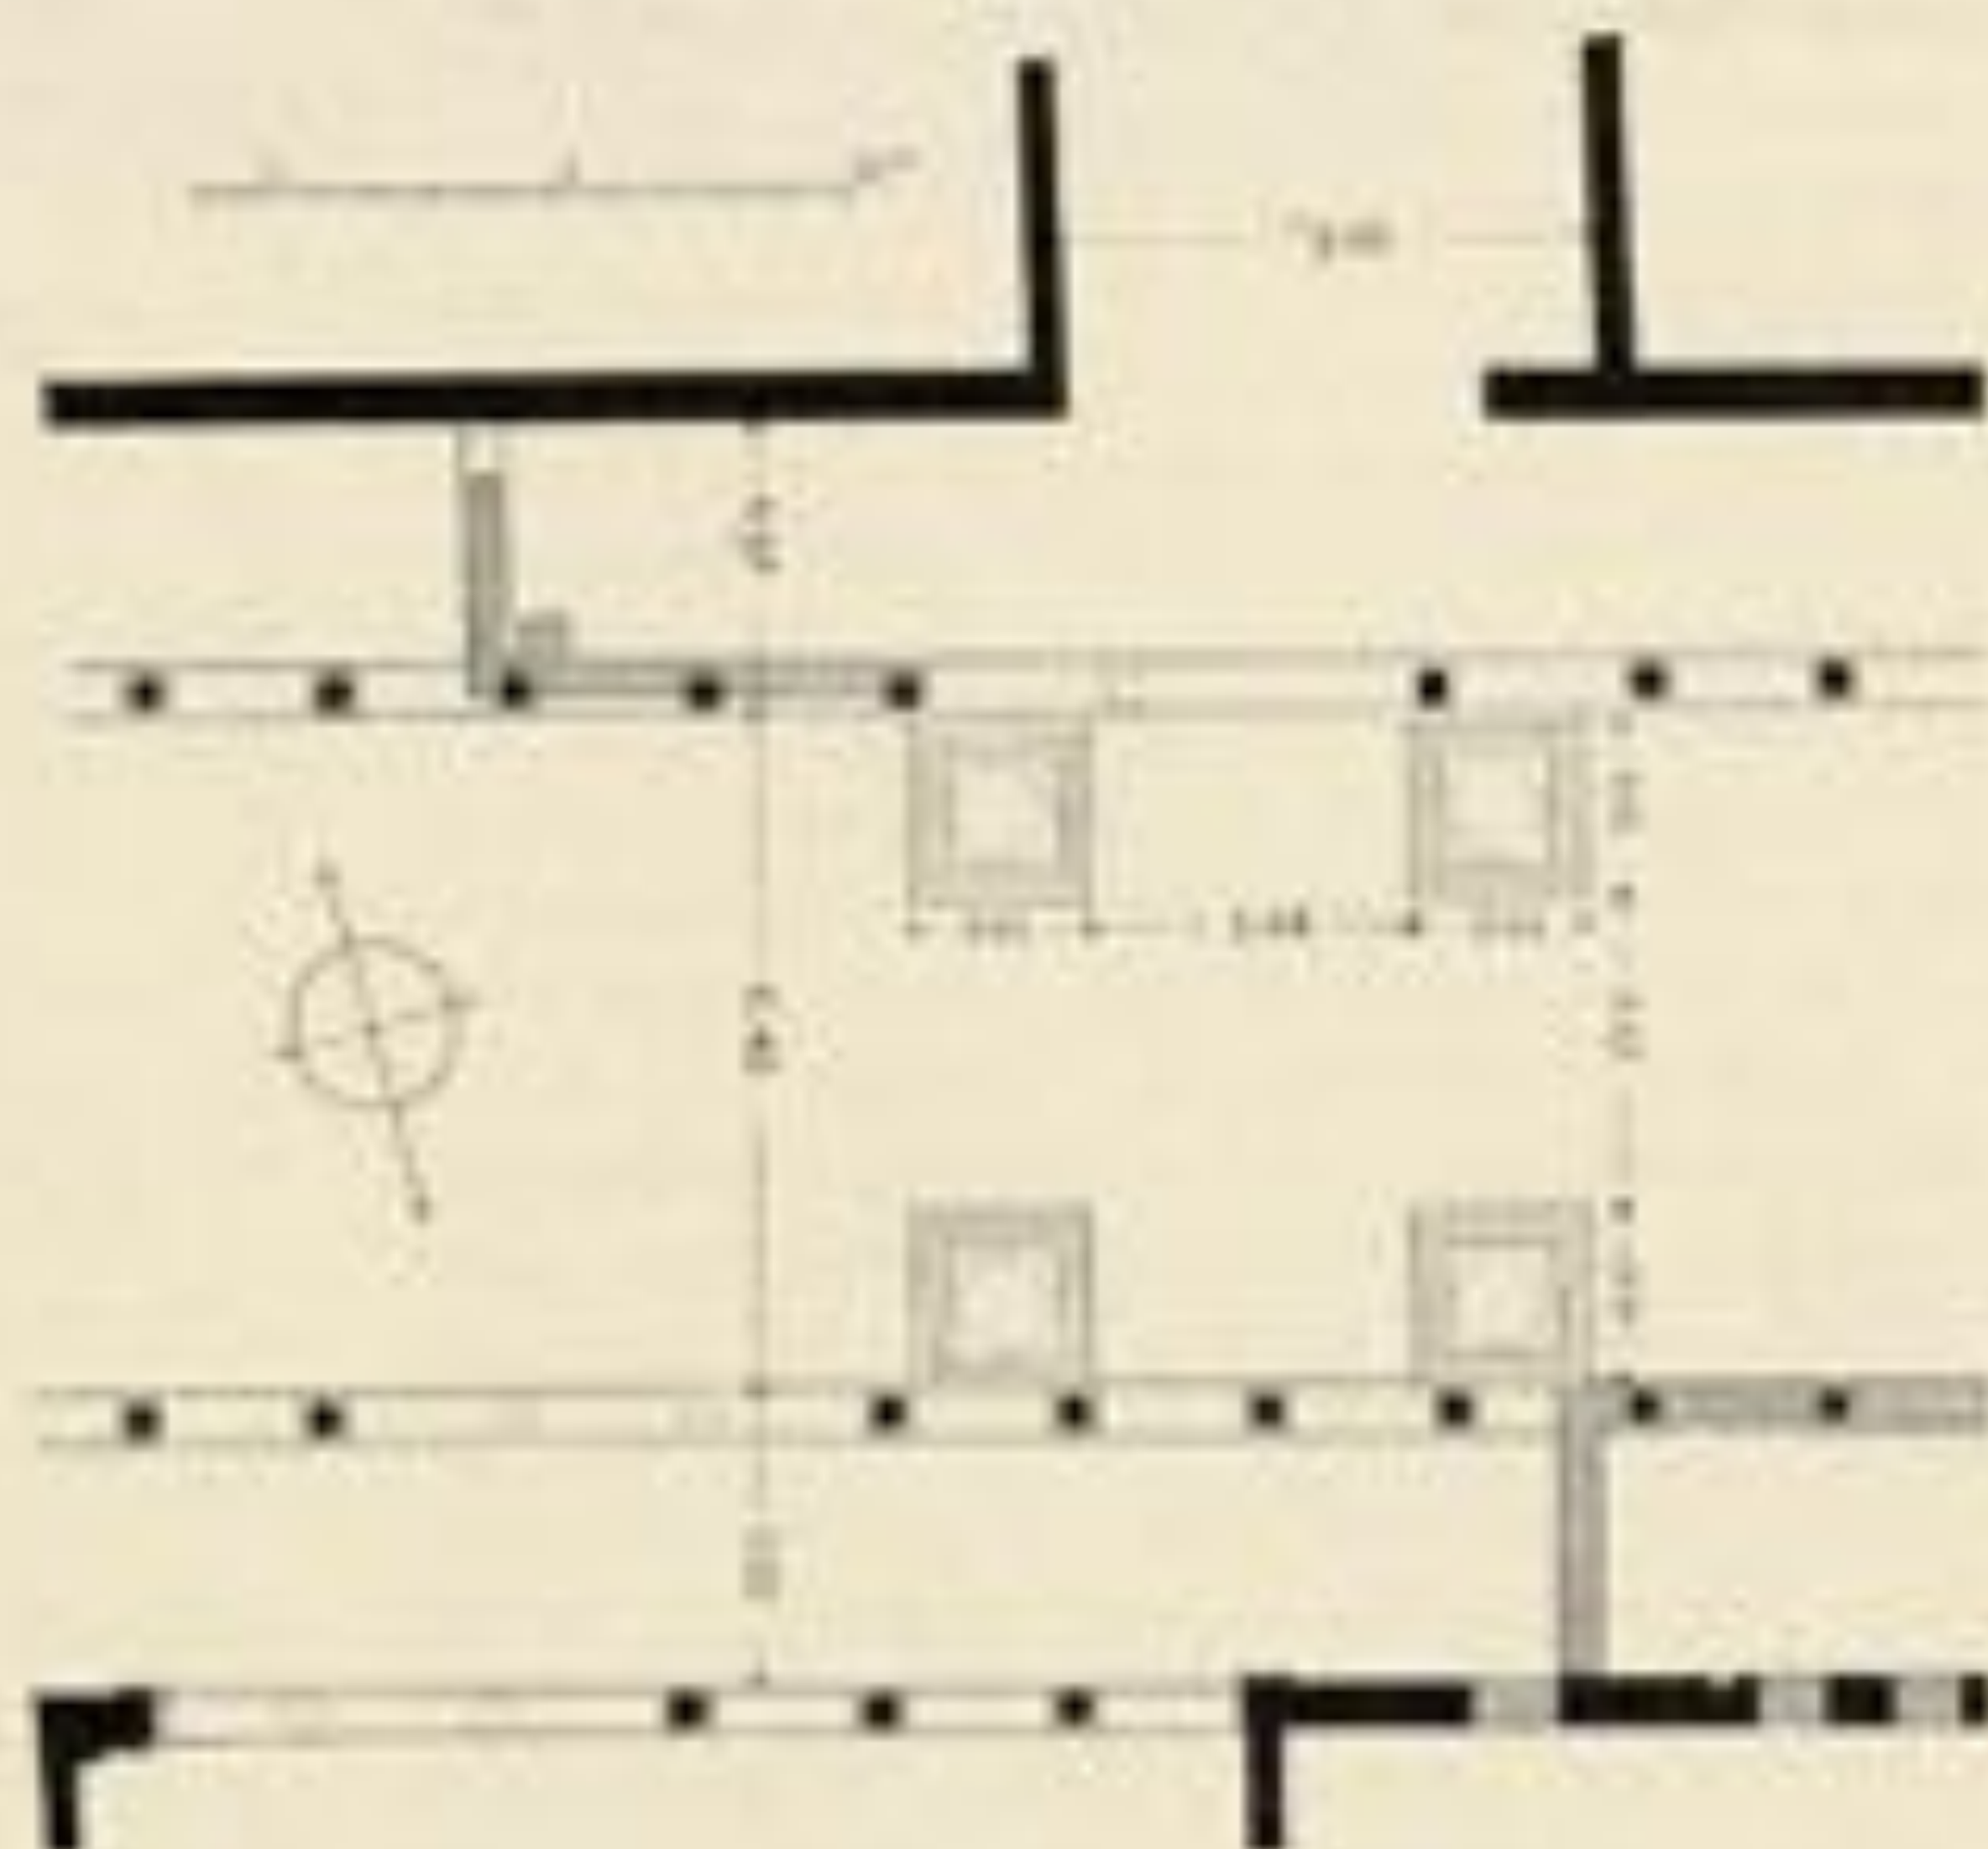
Grundriss der Arkadien bei der Nordostmauer.
